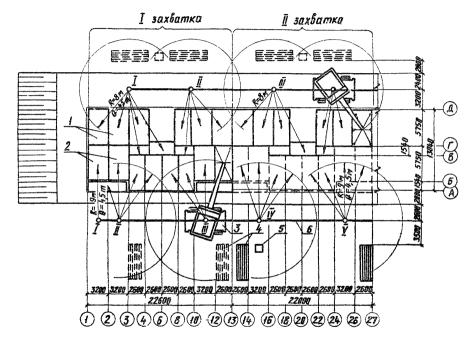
Схема организации работ по монтаку панелей перекрытия технического подполья: I-панели смонтированные краном В I; 2-панели смонтированные краном В 2; 3-пневмоколесный крае R-I6I; 4-панели в кассетах; 5-ящи для раствора; 6-ось док-жения крана; 1,1, E, IY, У-стоянки крана
